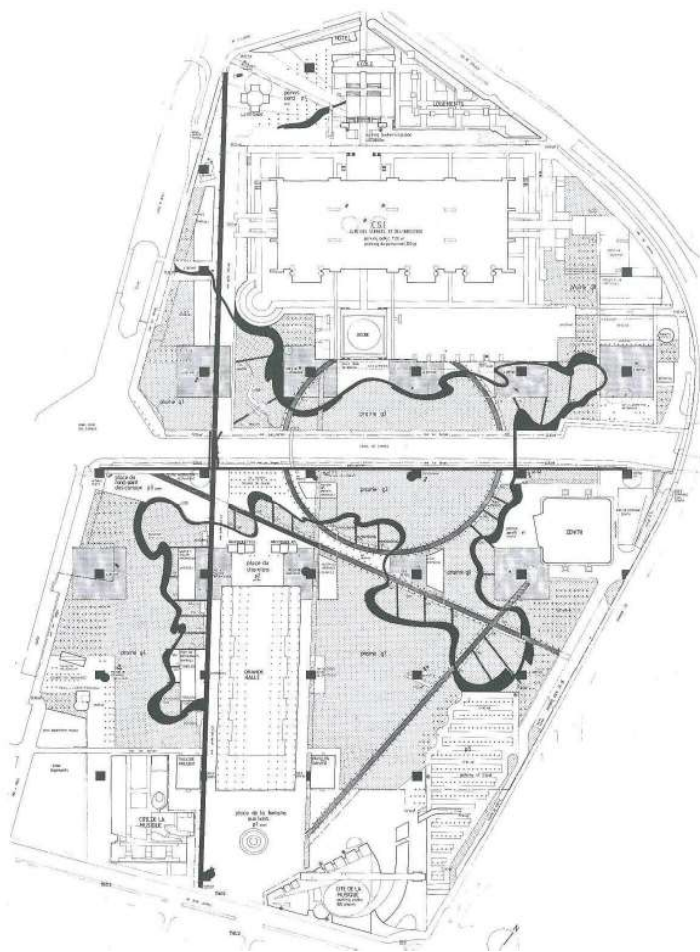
Planimetría Parc de la Villete, Bernard Tschumi.
